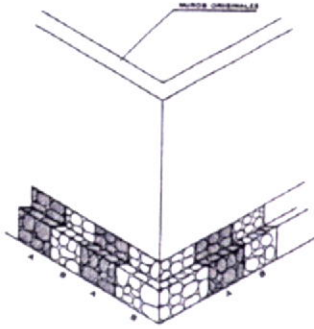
Esquema de substituição de fundação, com substituição faseada de pequenos troços, (primeira fase -execução dos troços A e posteriormente dos troços B)
